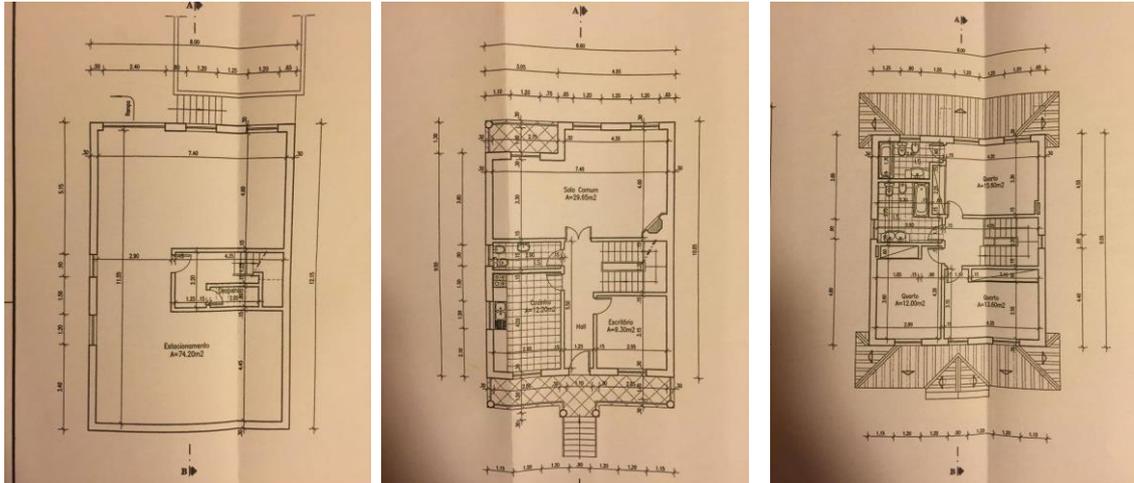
Planta Rés-do-Chão / Planta piso 1 / Planta piso 2
